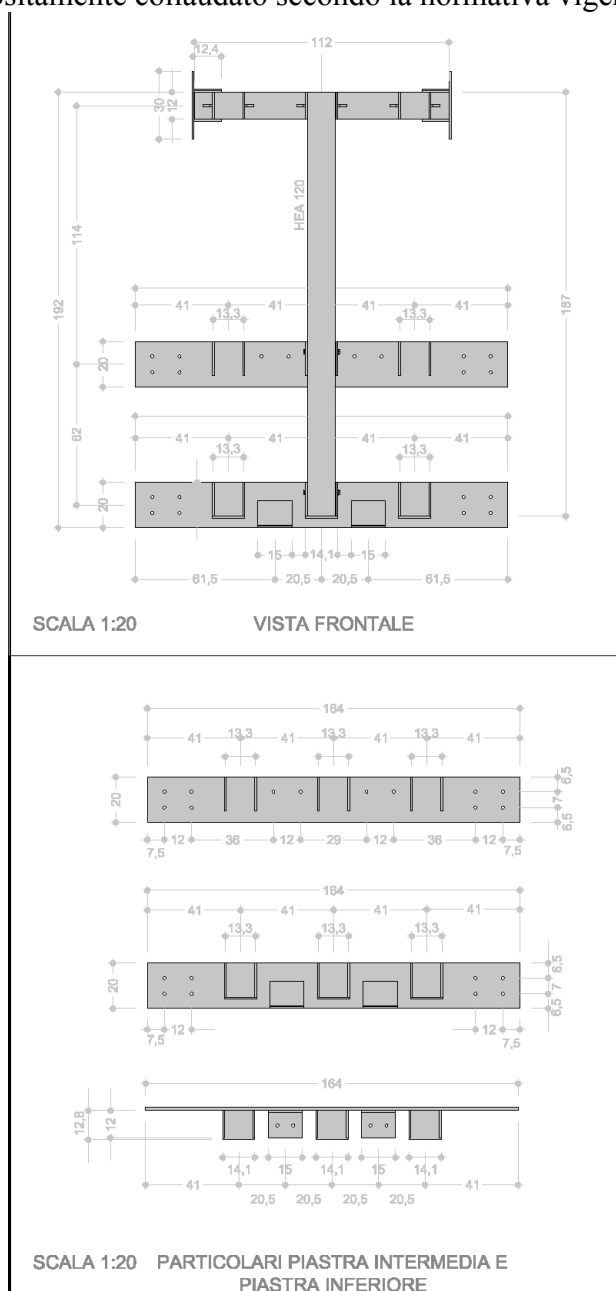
Schema tecnico dell'ancoraggio e distanziatore in acciaio. Vista frontale e particolare.
